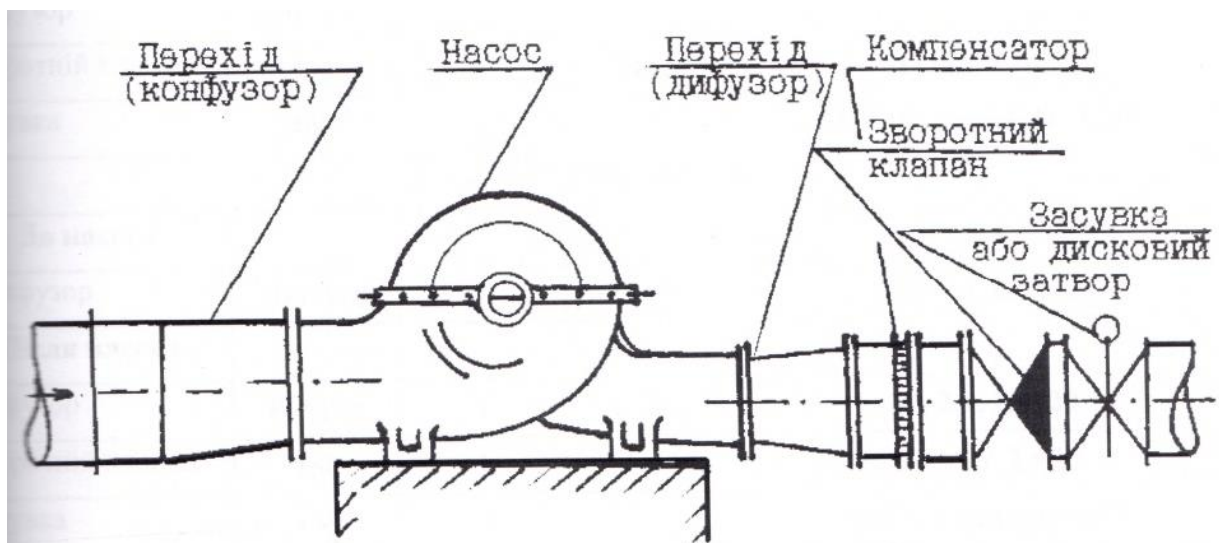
Схема установки трубопроводної арматури біля насоса
